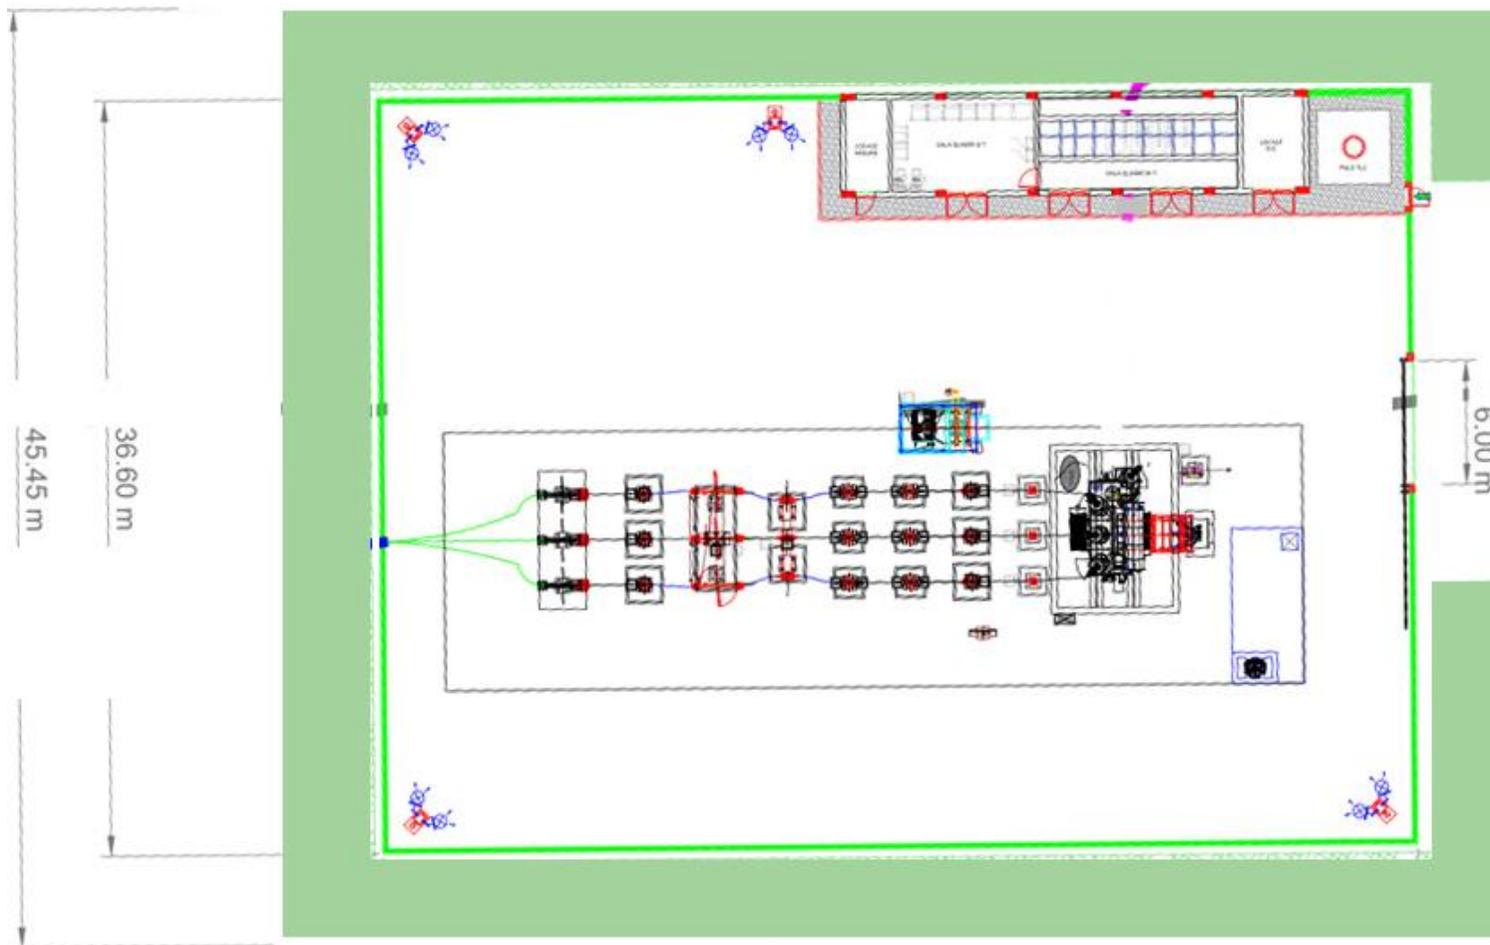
Planimetria della Stazione di Elevazione Utente SEU
